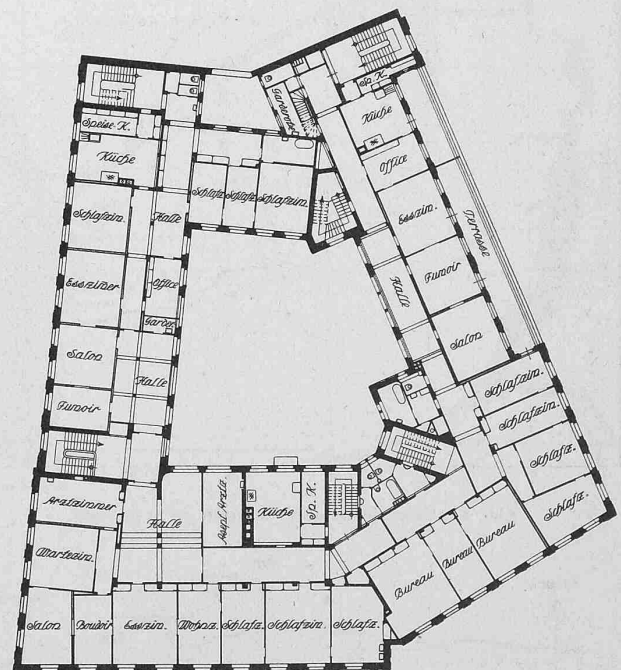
Grundriss vom III. Stock. — 1:600.
